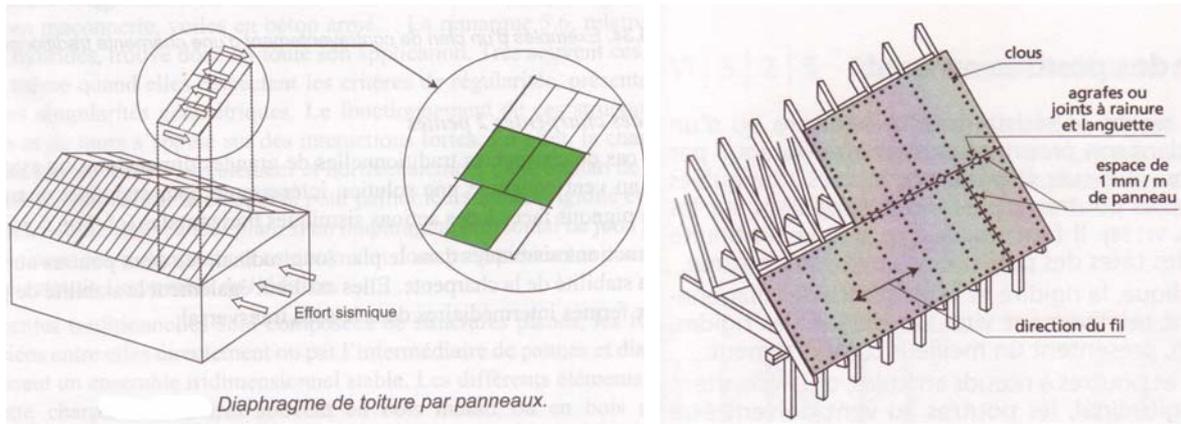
Constitution du diaphragme en toiture (*adapter*)
